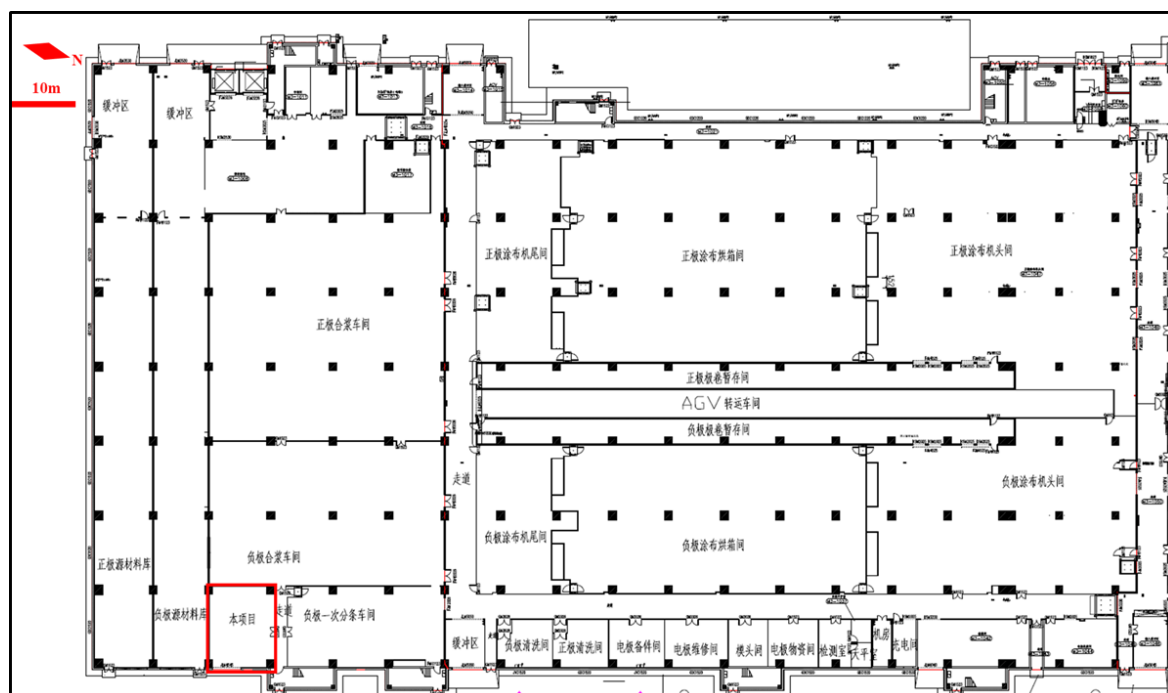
本项目所在 M3 厂房一层平面图（局部）
